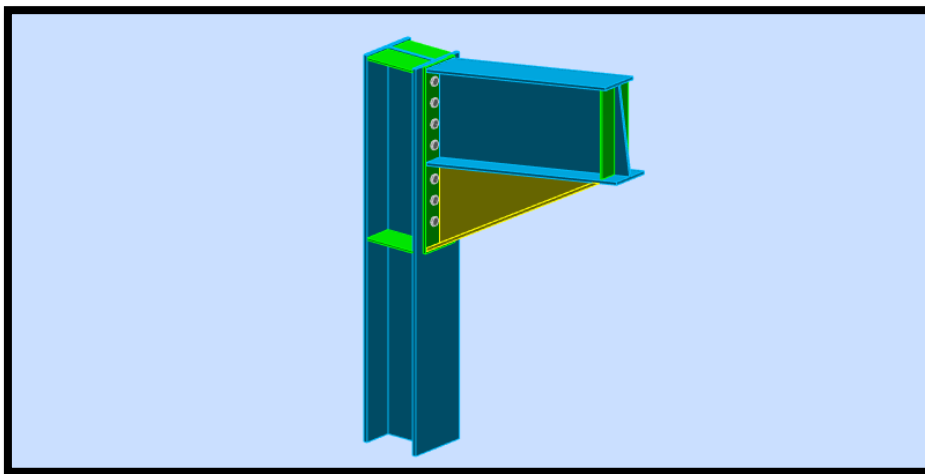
Représentation de l'assemblage poteau-traverse
